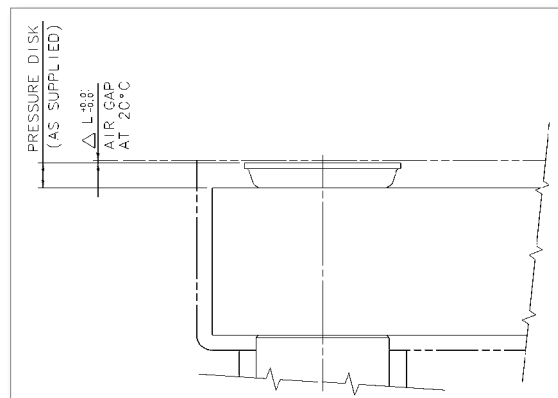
Montagedetail für die optionale Druckscheibe
